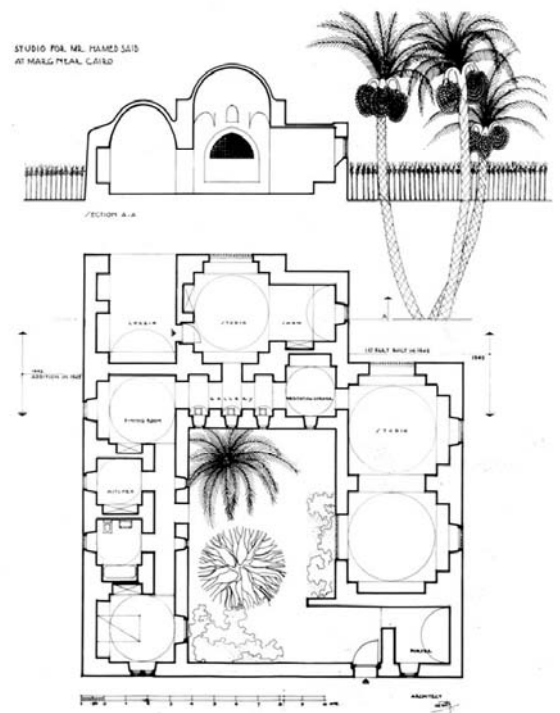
Planos y fotografías de la casa para Hamed Said. 1942
